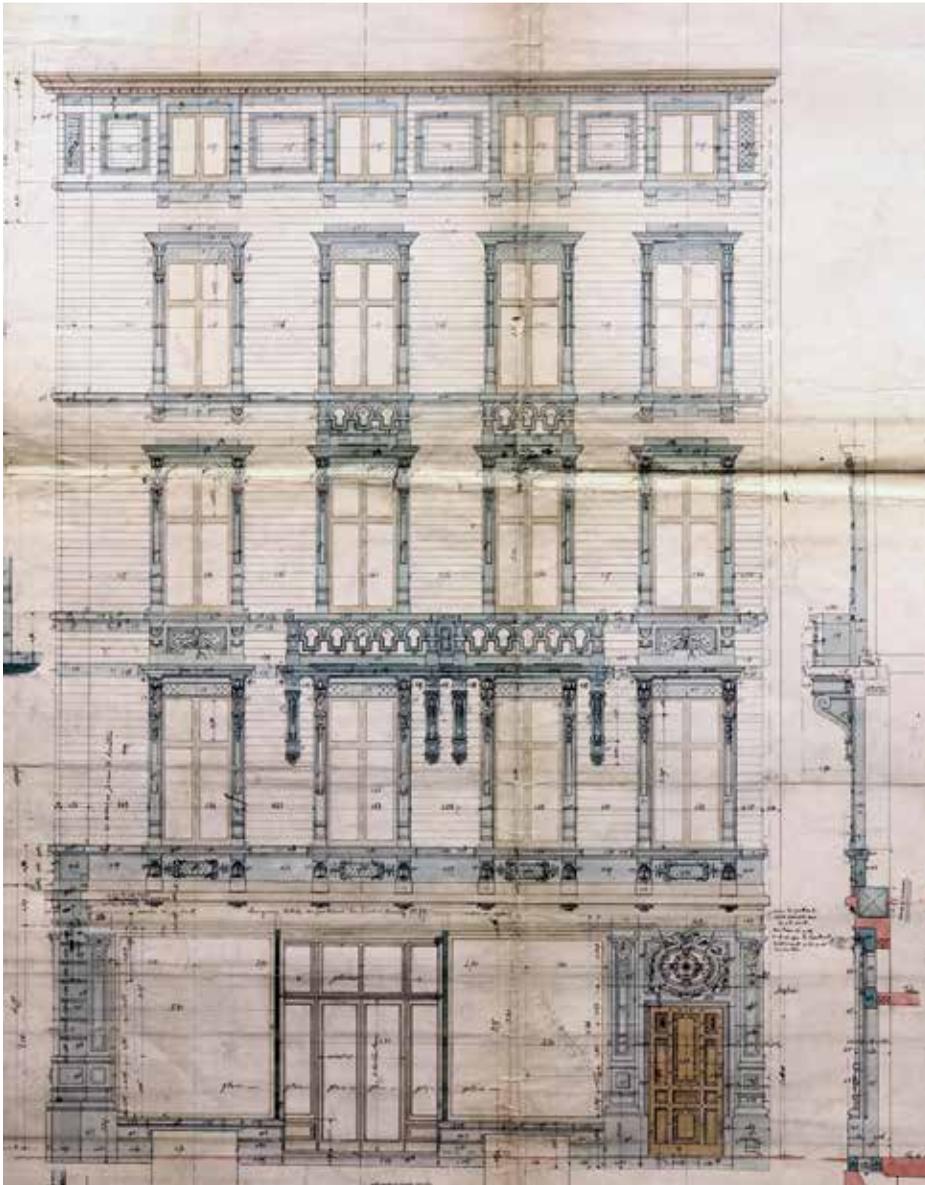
Immeuble n° 1, façade latérale rue Pont d'Avroy.
